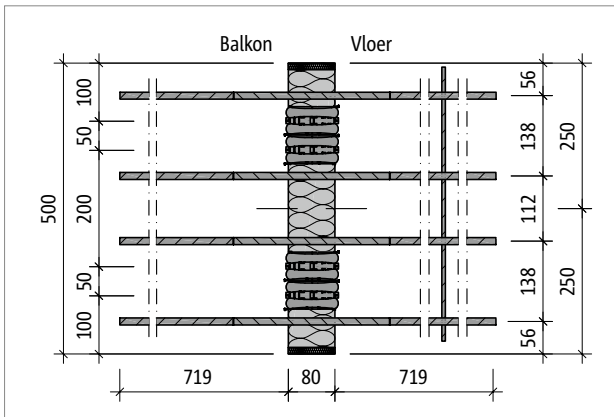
Schöck Isokorb® T type Q-E-V6: Bovenaanzicht
